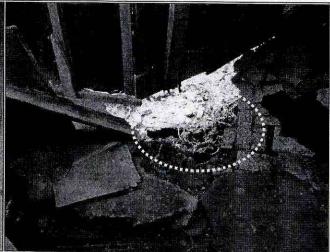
Detalle del piso de la vivienda de la Calle 82 Sur 42 - 76 (Lote 13 Manzana 84), donde se aprecian grietas de tracción.
